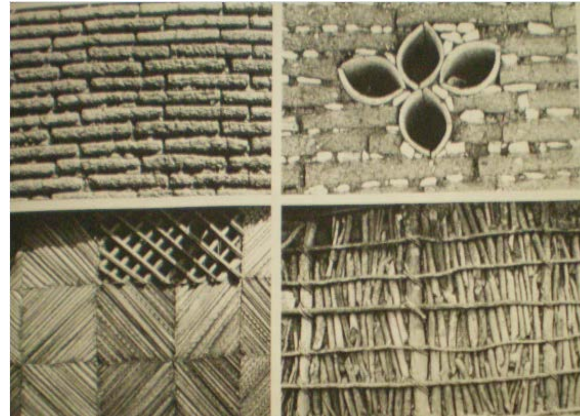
Material de la región para la construcción de muros en la zona montañosa de Guerrero.
